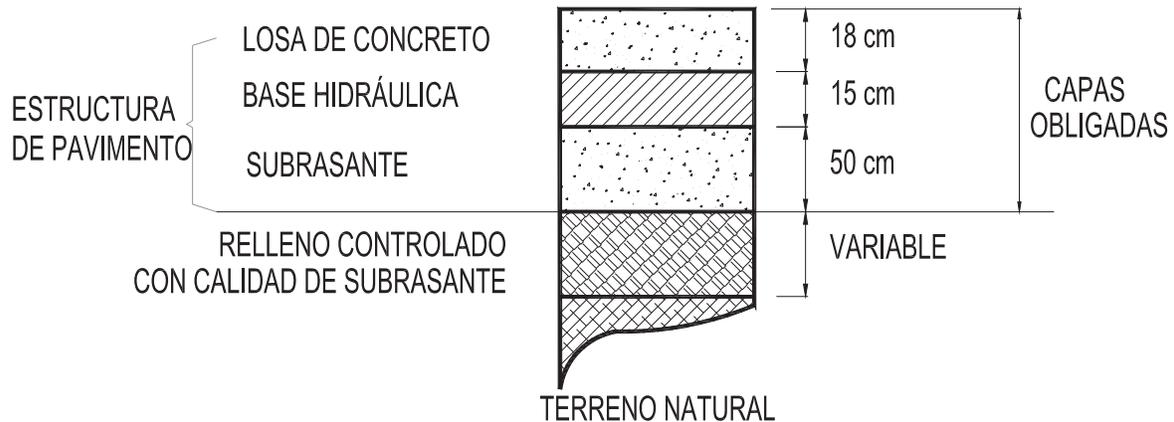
Estructura de pavimento rígido en zona de trailers o acceso vehicular.
